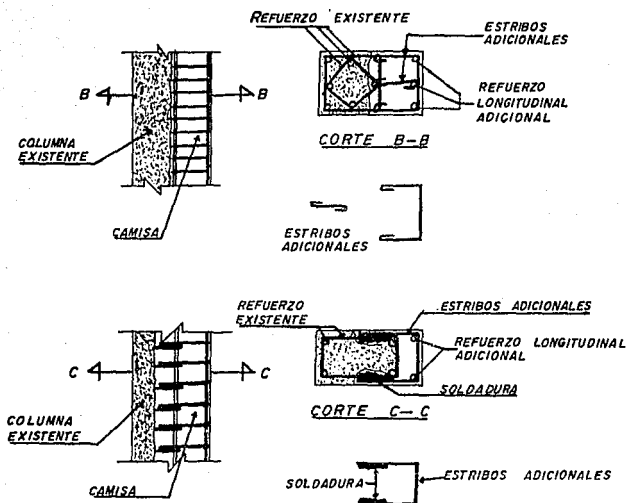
Técnicas para encamisado de columnas con concreto reforzado.
